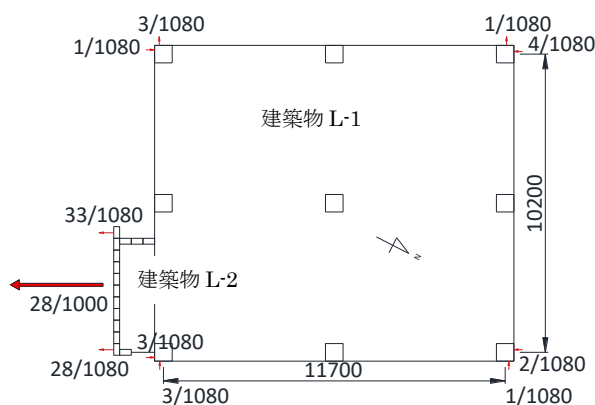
建築物 L-1 および L-2 の概略平面図
